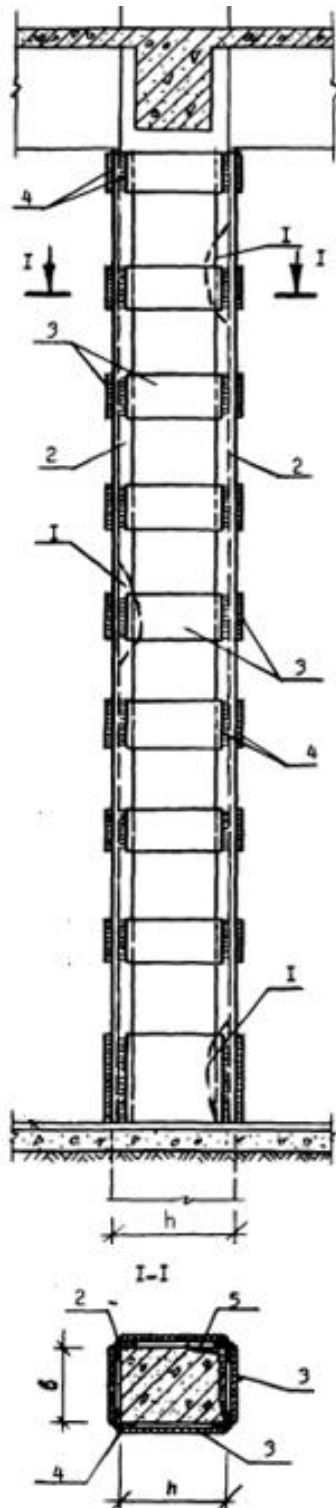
Конструктивна схема підсилення колони металевою обоймою: 1 – зона пошкодження; 2 – кутик; 3 – сталевий лист; 4 – зварний шов; 5 – зачеканка розчином
